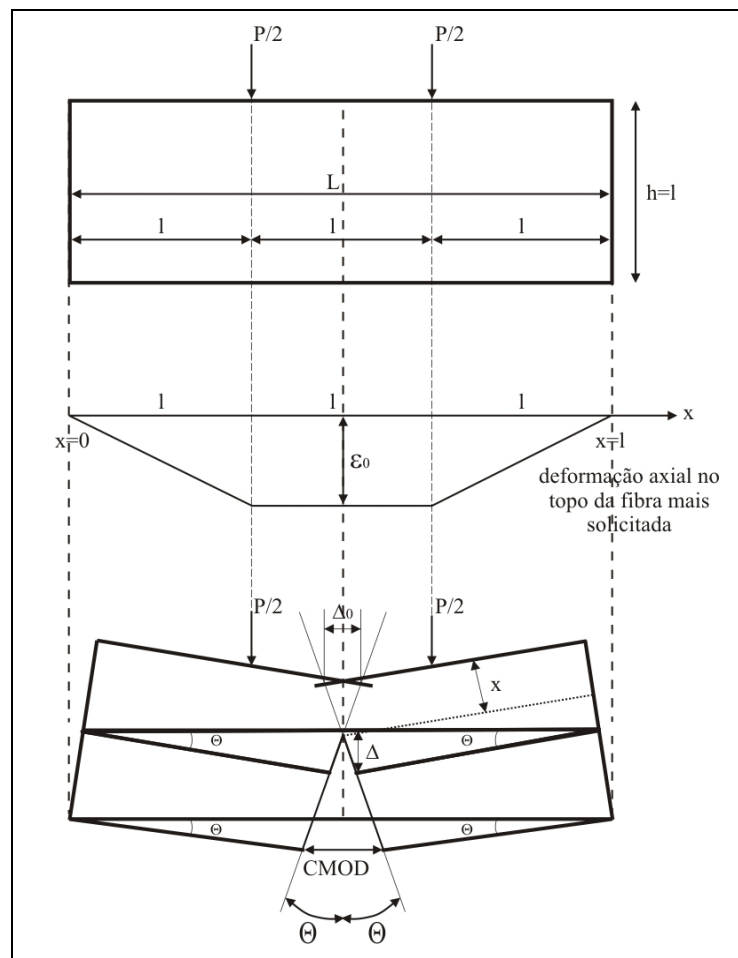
Configuração da ruptura da viga indicando as relações entre deformações, abertura de fissuras e deslocamentos admitidos no modelo de Prudêncio Jr. et al. (2006).
